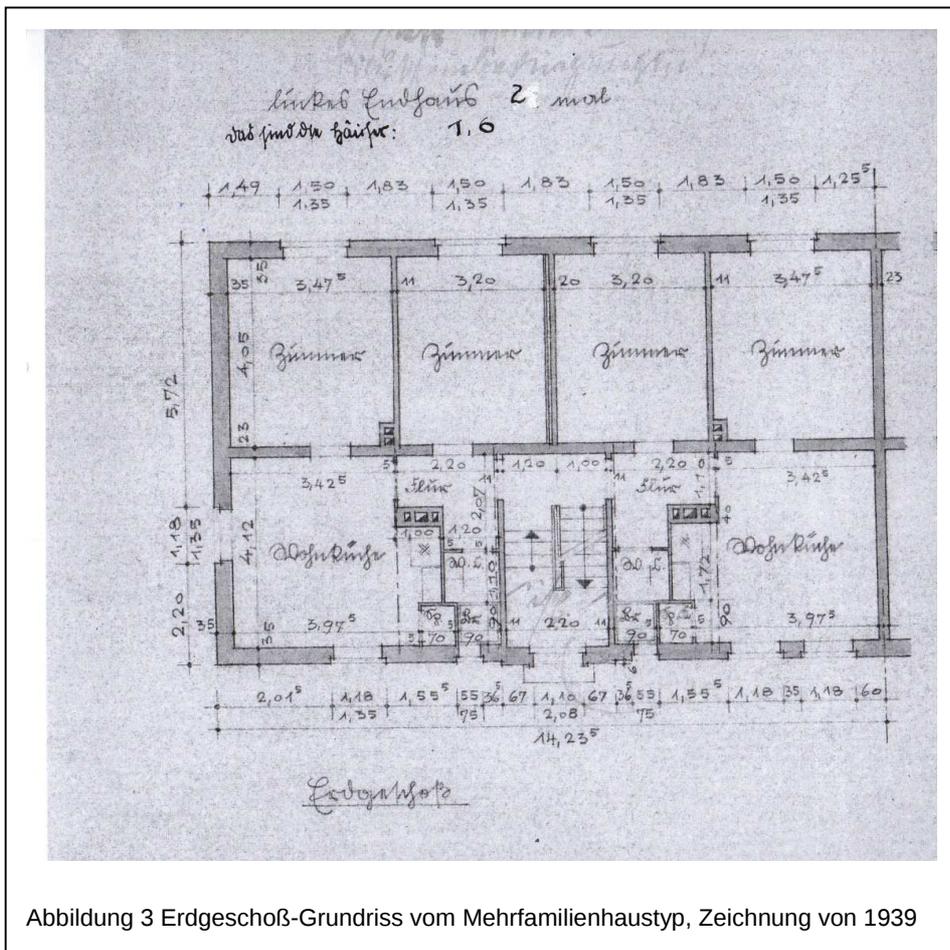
Erdgeschoß-Grundriss vom Mehrfamilienhaustyp, Zeichnung von 1939
